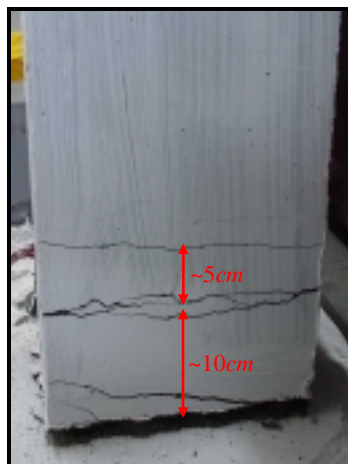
(b) - Fissuração da face traccionada do modelo M2G1.
